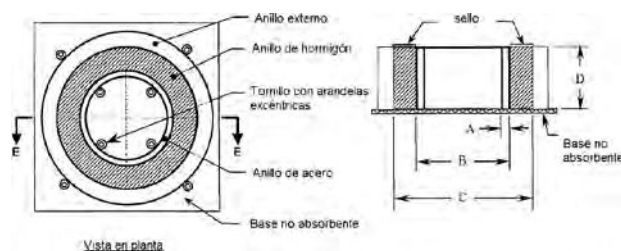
Dimensiones de la probeta del ensayo ASTM C 1581
